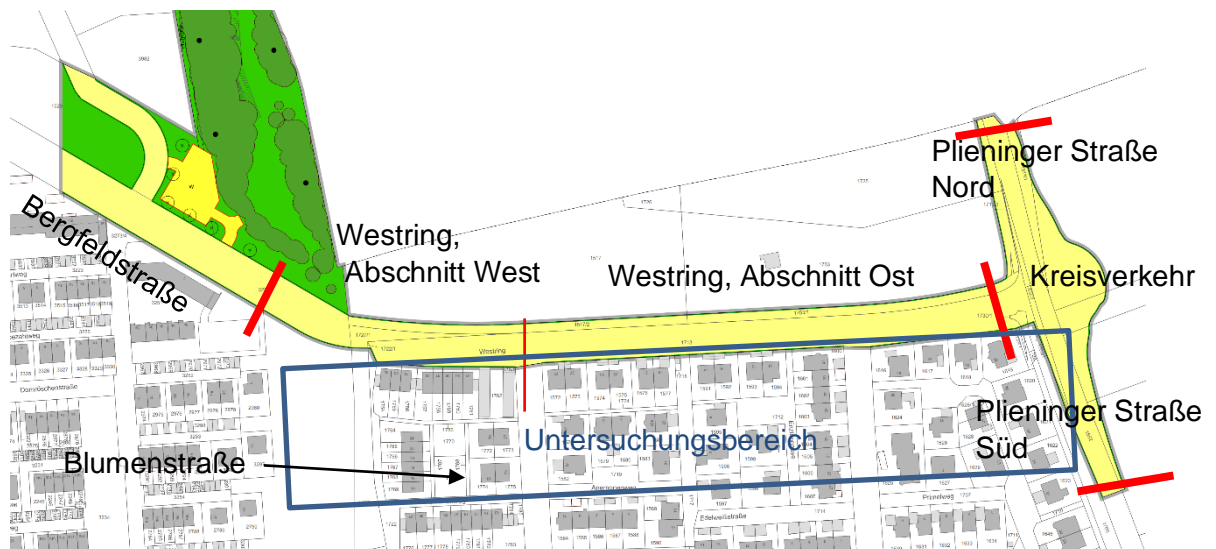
Ausschnitt Planzeichnung zur 1. Änderung Bebauungsplan der Abschnitte West und Ost des Westrings [9].
